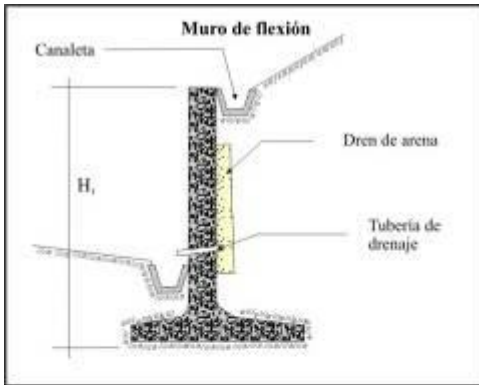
Muros en L (tomado de INGEMMET, 2000).
